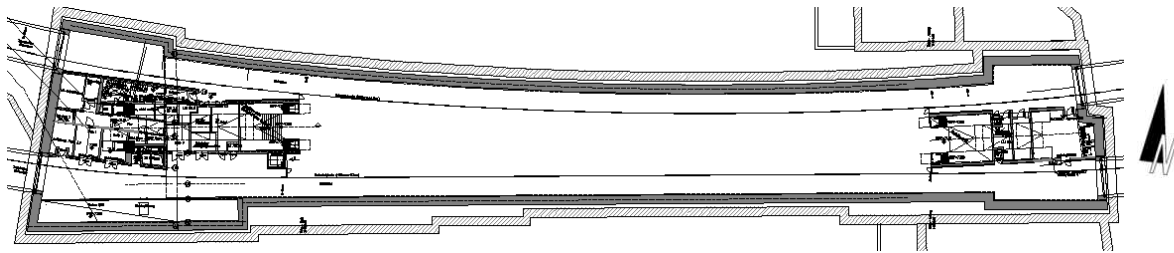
Grundriss der Fahrebene (C-Ebene) der Station „Güterplatz“
